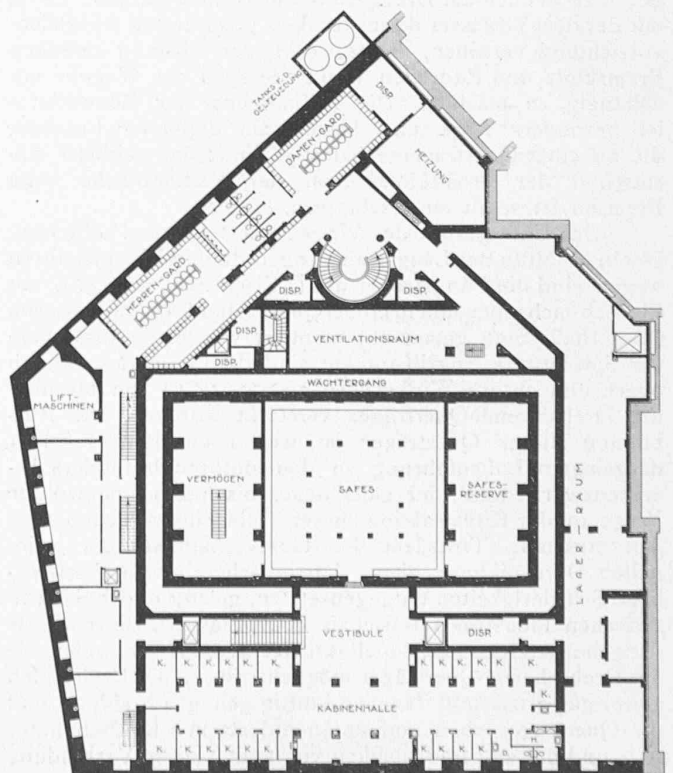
Grundriss des I. Untergeschosses.
